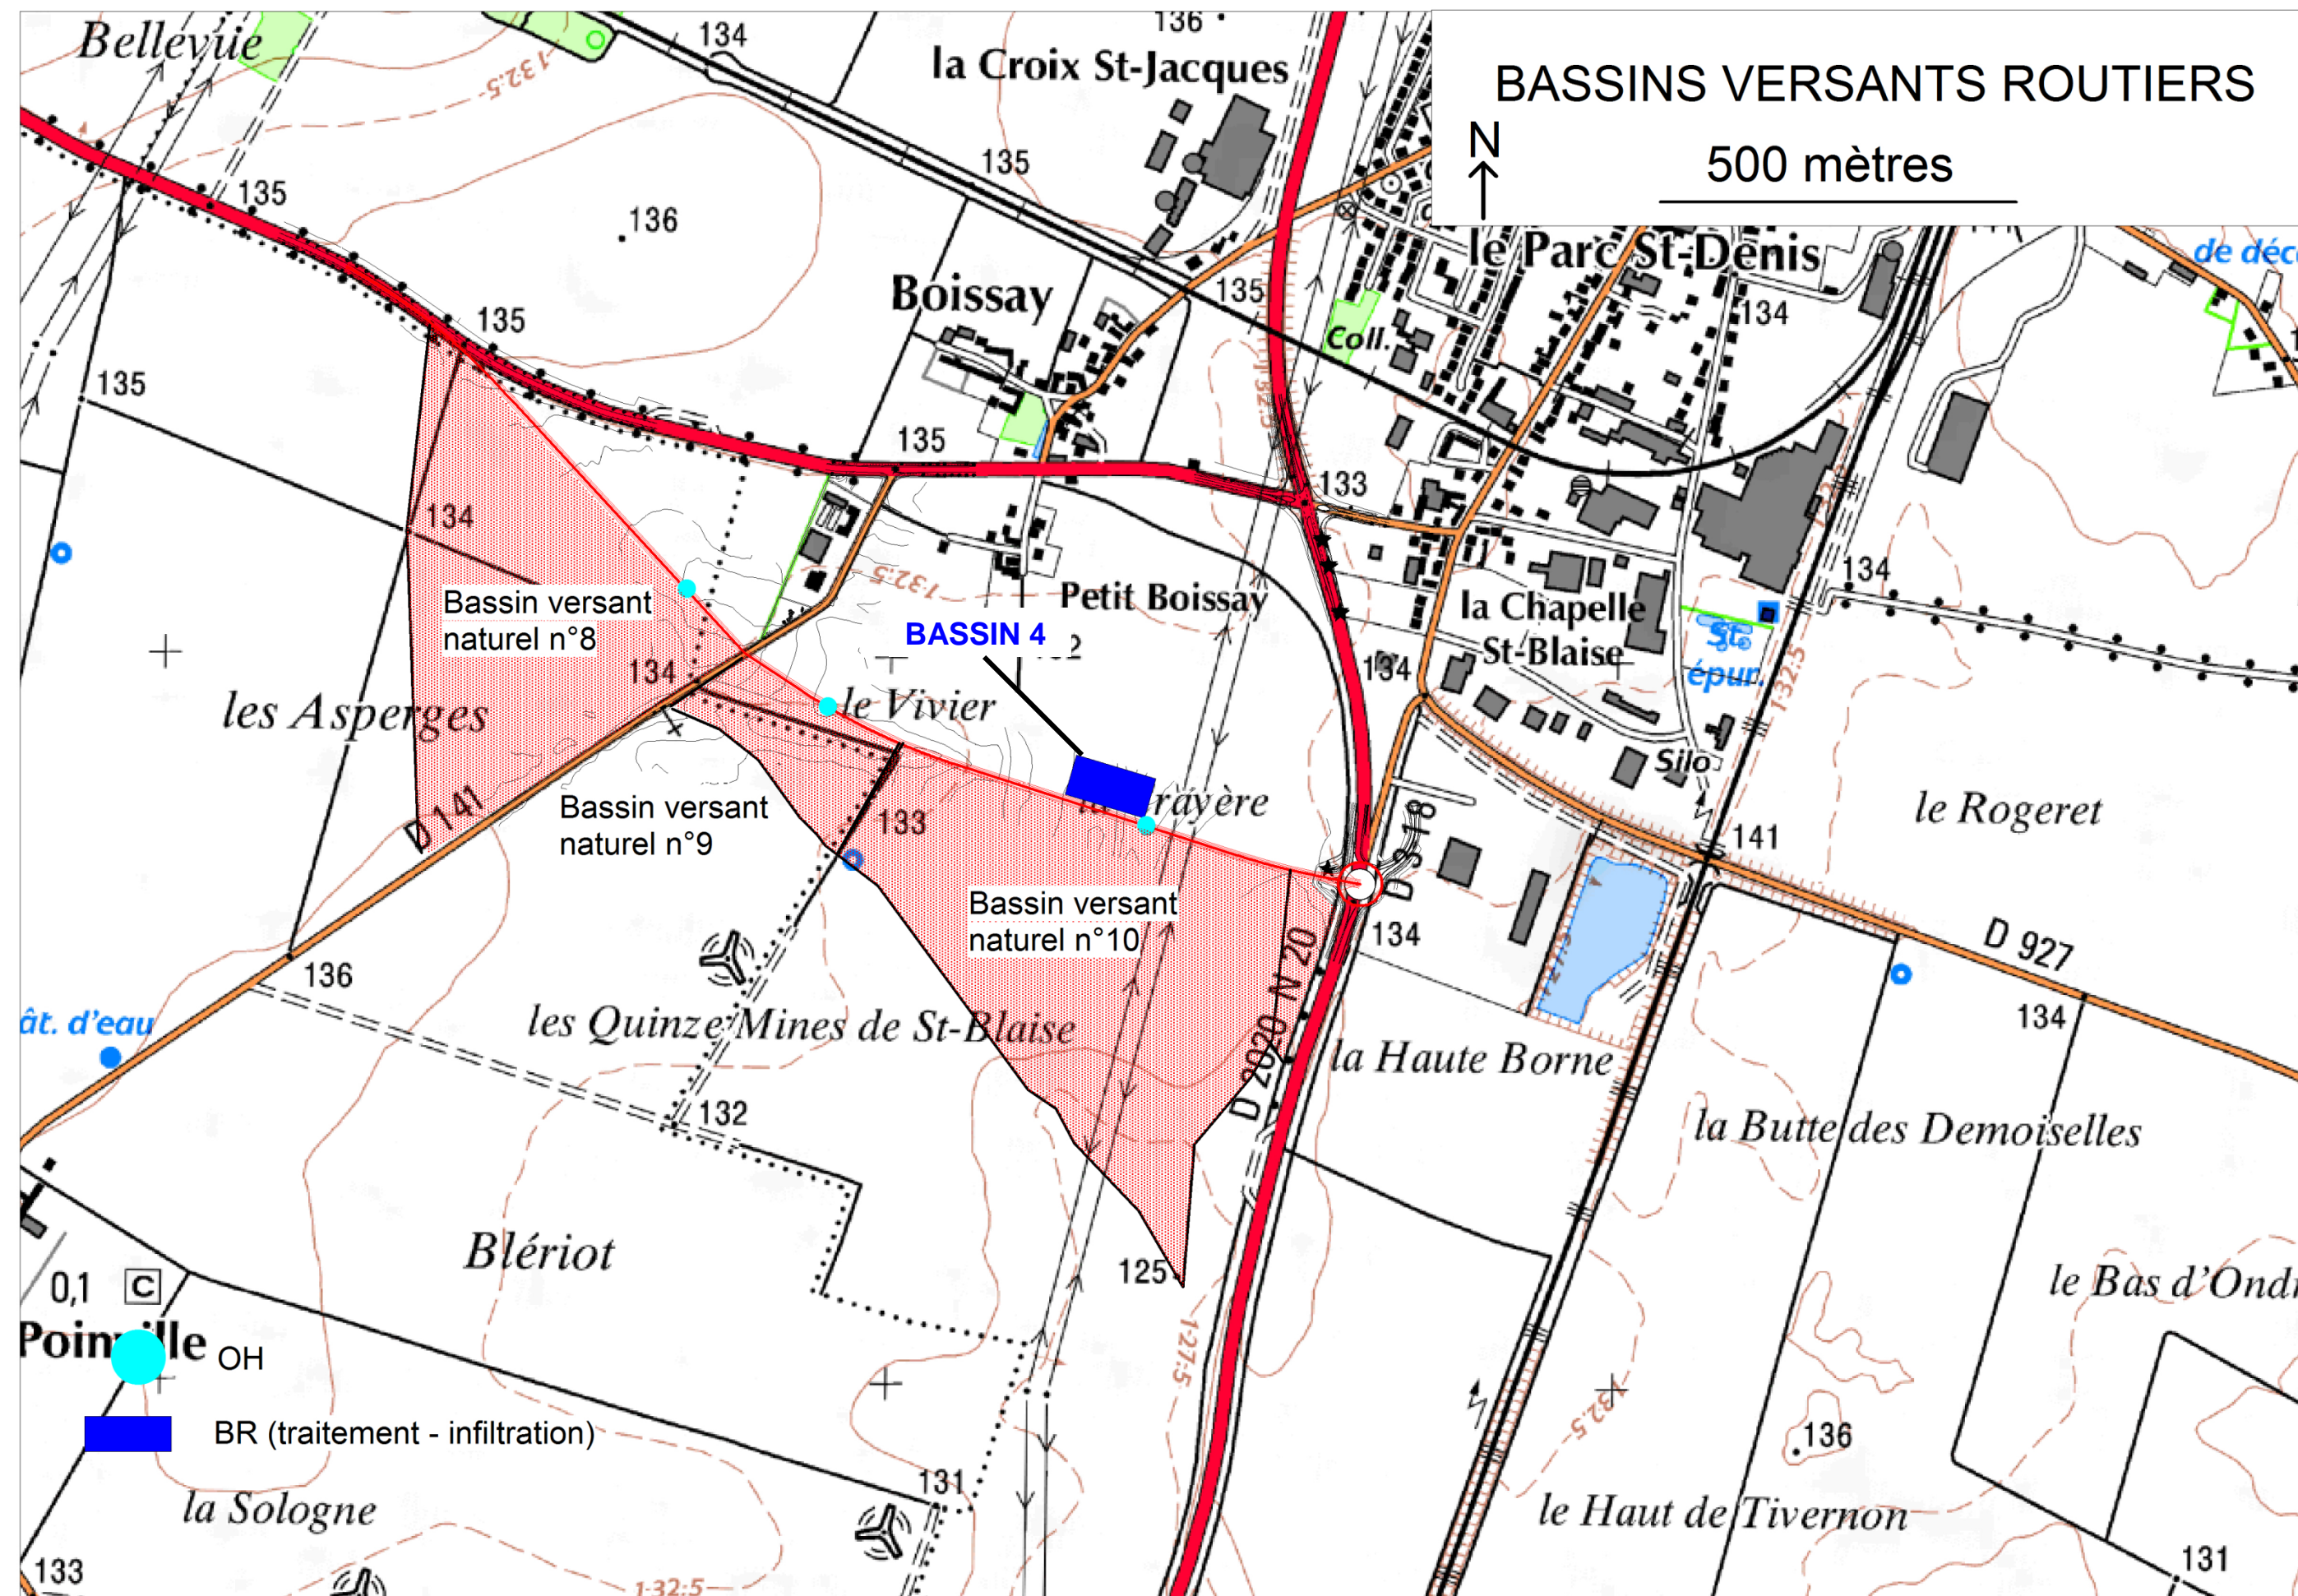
Vue en plan 4/4 du projet (section Petit Boissay)
